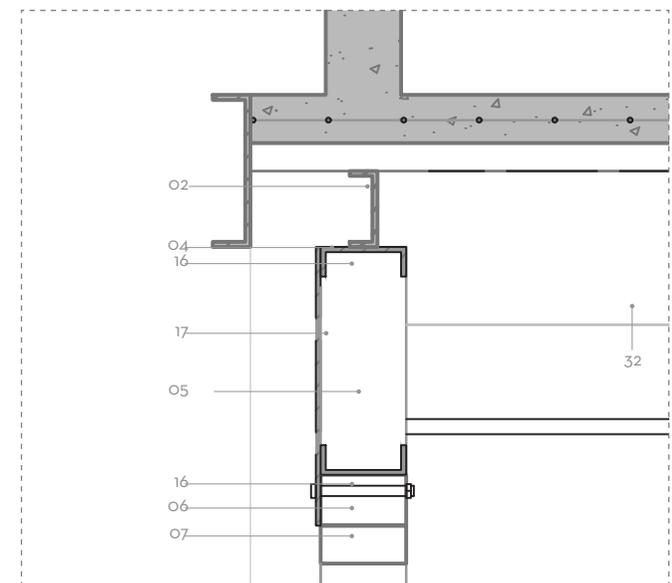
Det_eo1. Detalle constructivo específico de anclaje superior Escala: 1:15 Fuente: Los autores
